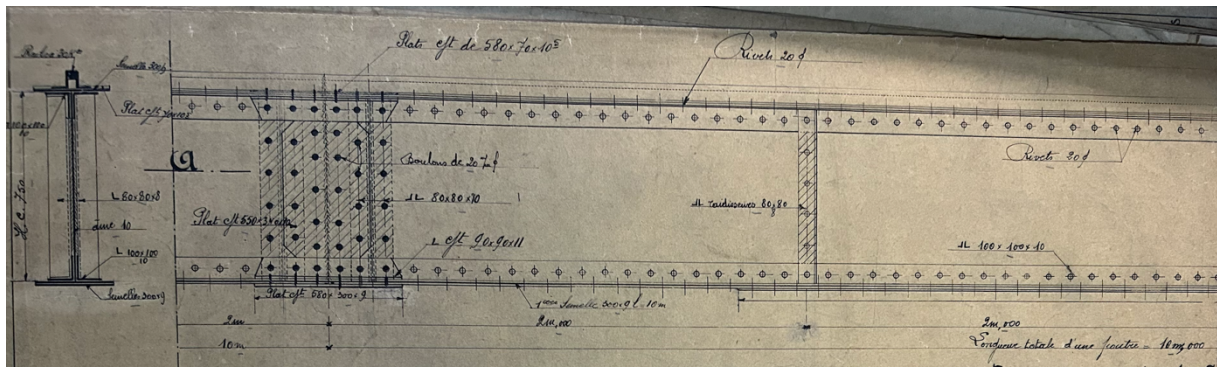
Plan en élévation des longerons des ponts roulants, Exposition de Bruxelles 1910
